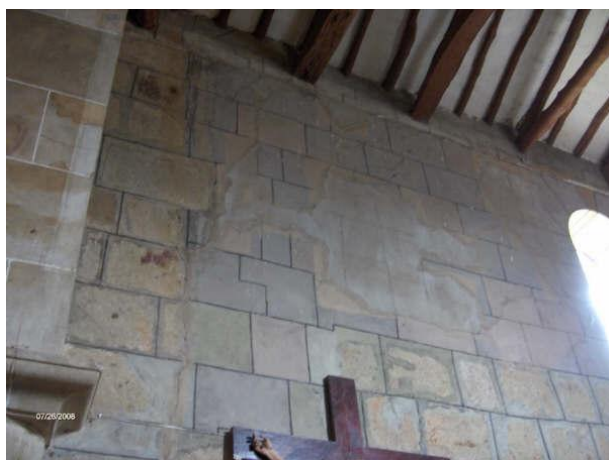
Fisuras Muro Lateral Derecho
